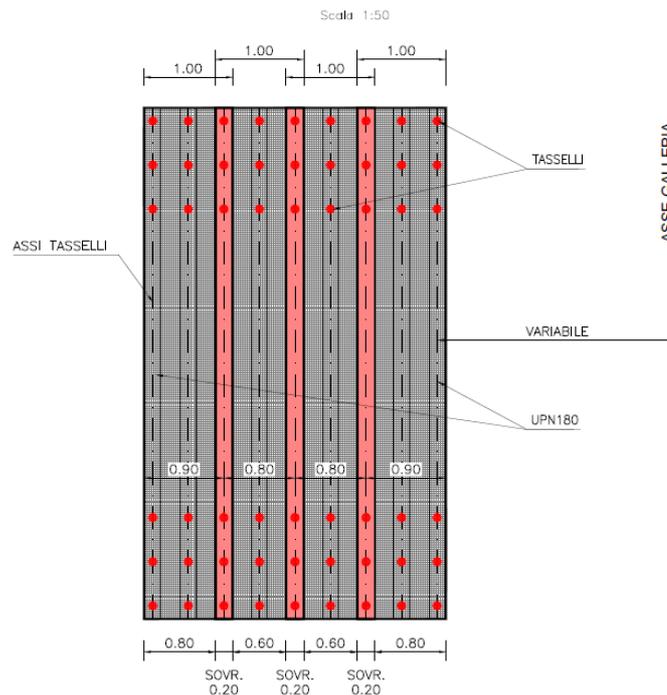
Disposizione reti con fogli di larghezza 1 m
